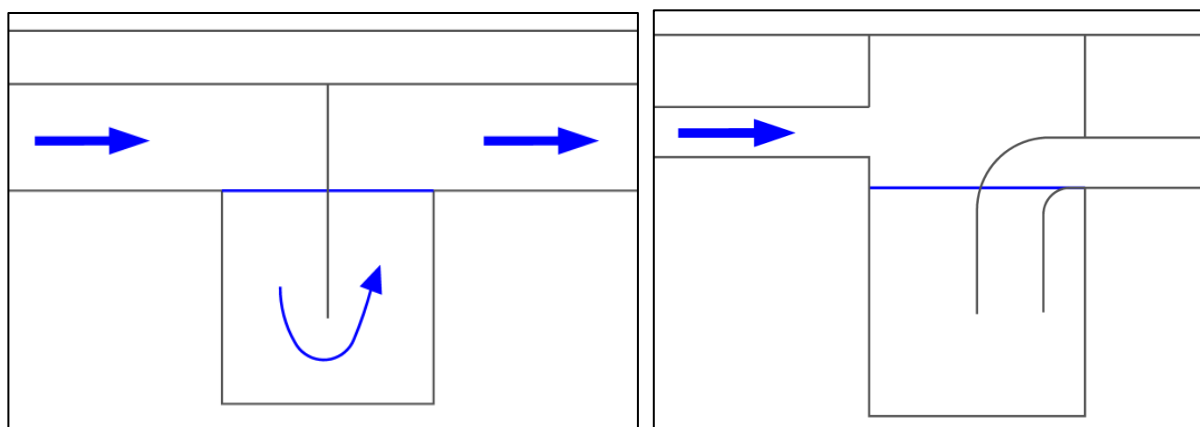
Schémas de principe de 2 exemples de zones de décantation (cloison siphonoïde et coude PVC)
